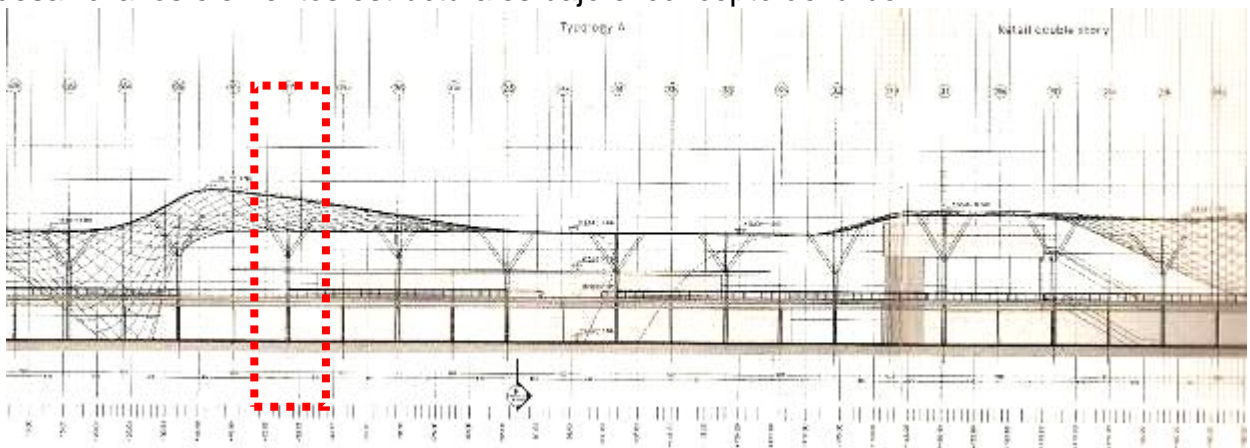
Corte interior de la Feria en donde se aprecian los elementos metálicos verticales que soportan toda la cubierta.
